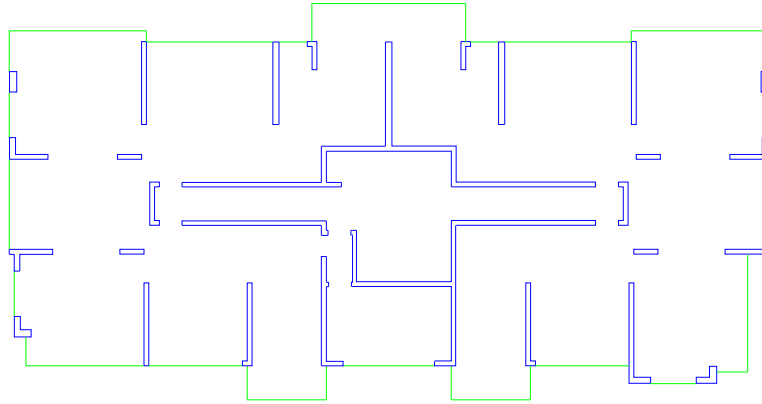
Ejemplo de muros y borde de losa para plano de ingeniería en AutoCAD
